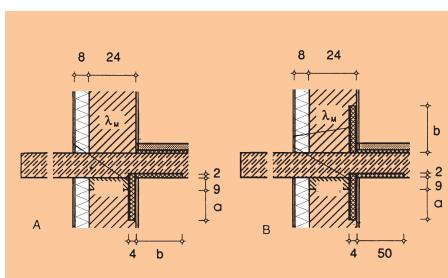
Неізольована залізобетонна консоль балконної плити,
